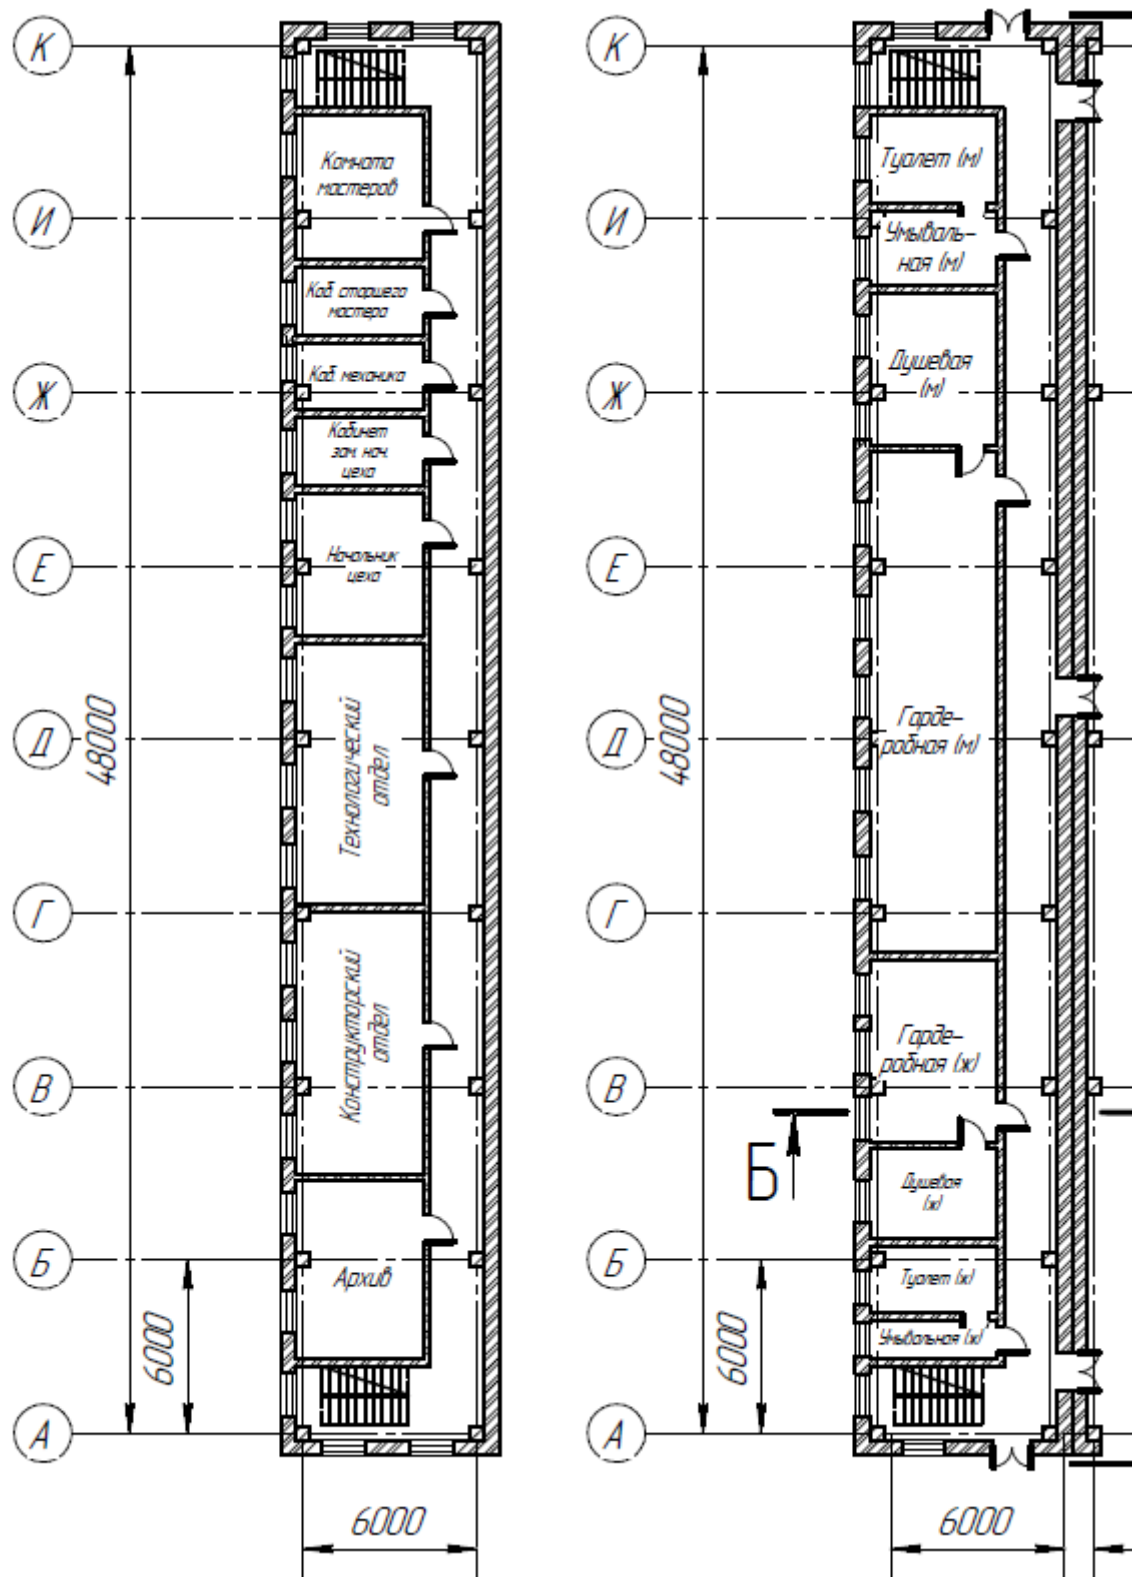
Примеры планировок бытовых и служебных помещений
